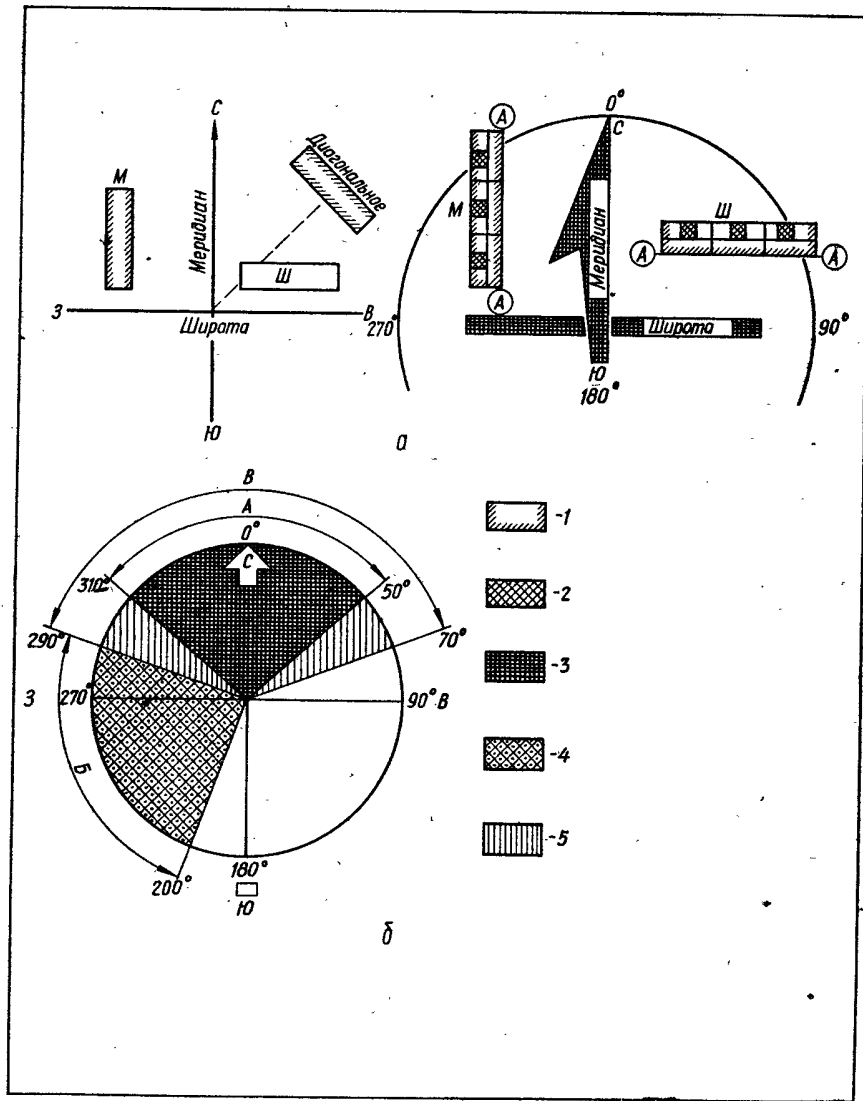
Нормированные условия ориентации жилых помещений:
